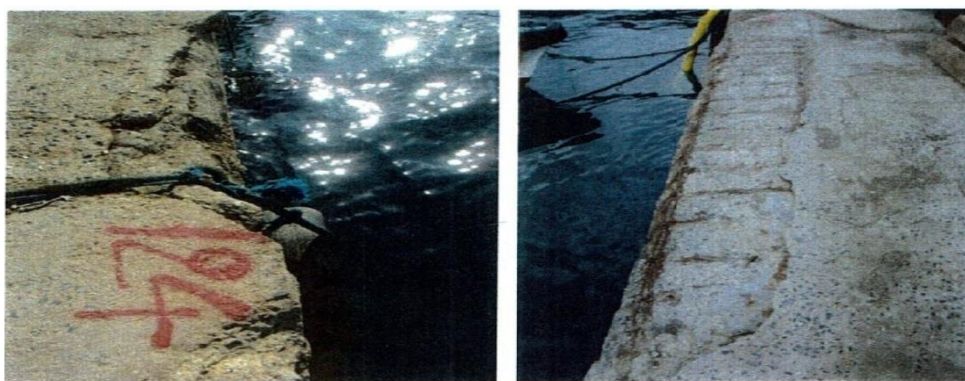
Béton de la poutre de couronnement dégradé avec ferrailage apparent.
